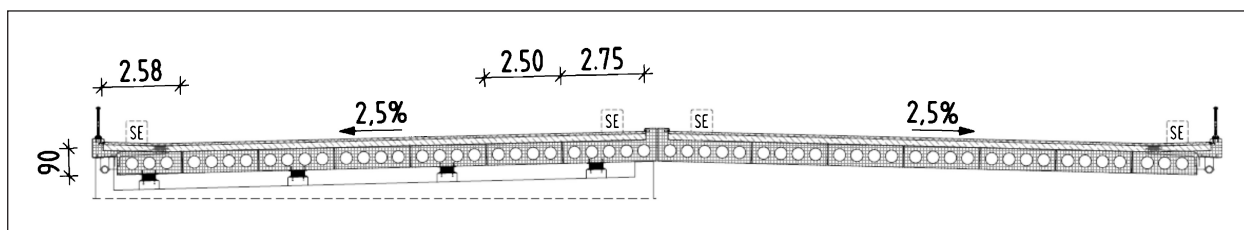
Spannbetonträger Trägerschar, mit Ortbetonerfüllung und integriertem Gesims
